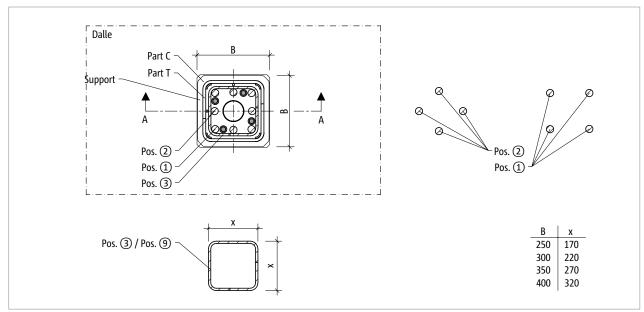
Schöck Sconnex® type P : renforcement sur site dans la section du poteau
